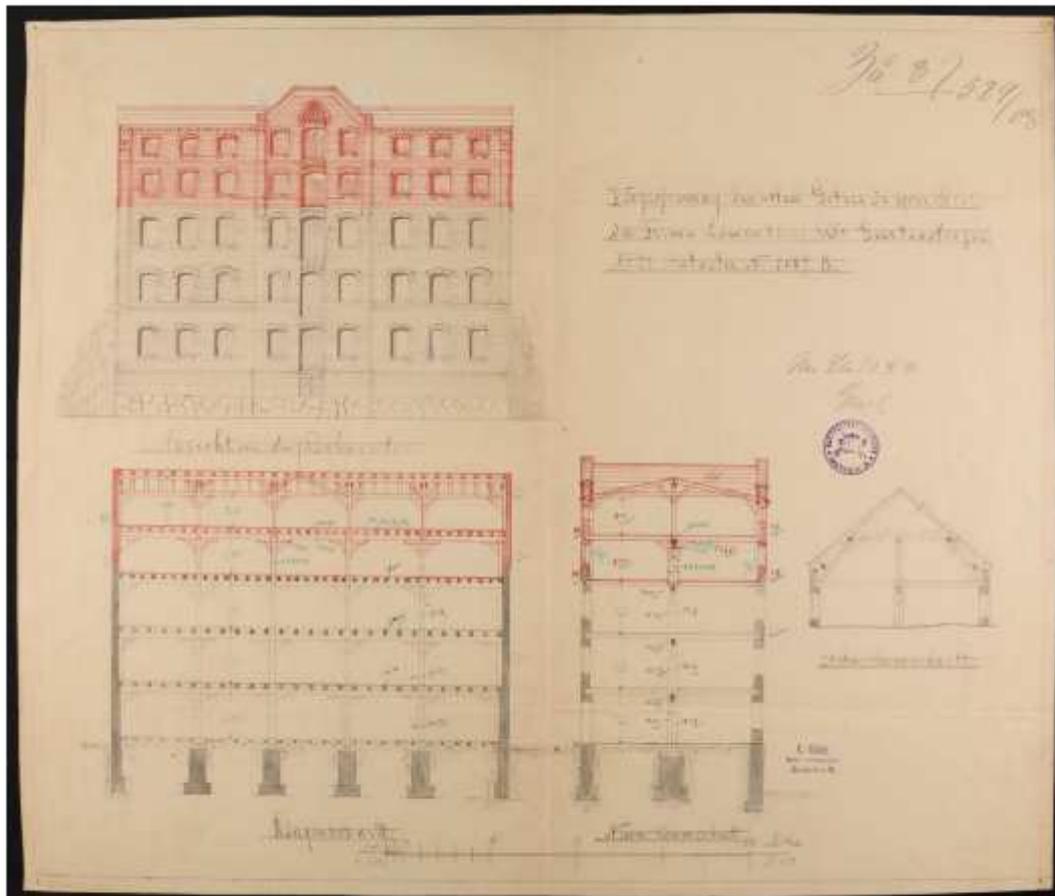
historischer Plan – Darstellung Speicher C Schnitte und Ansichten zur Aufstockung, später weitere Ergänzung eines Dachgeschosses mit Aufbau auf dem Dach als Maschinenraum für den Elevator (Quelle: Stadtarchiv)
